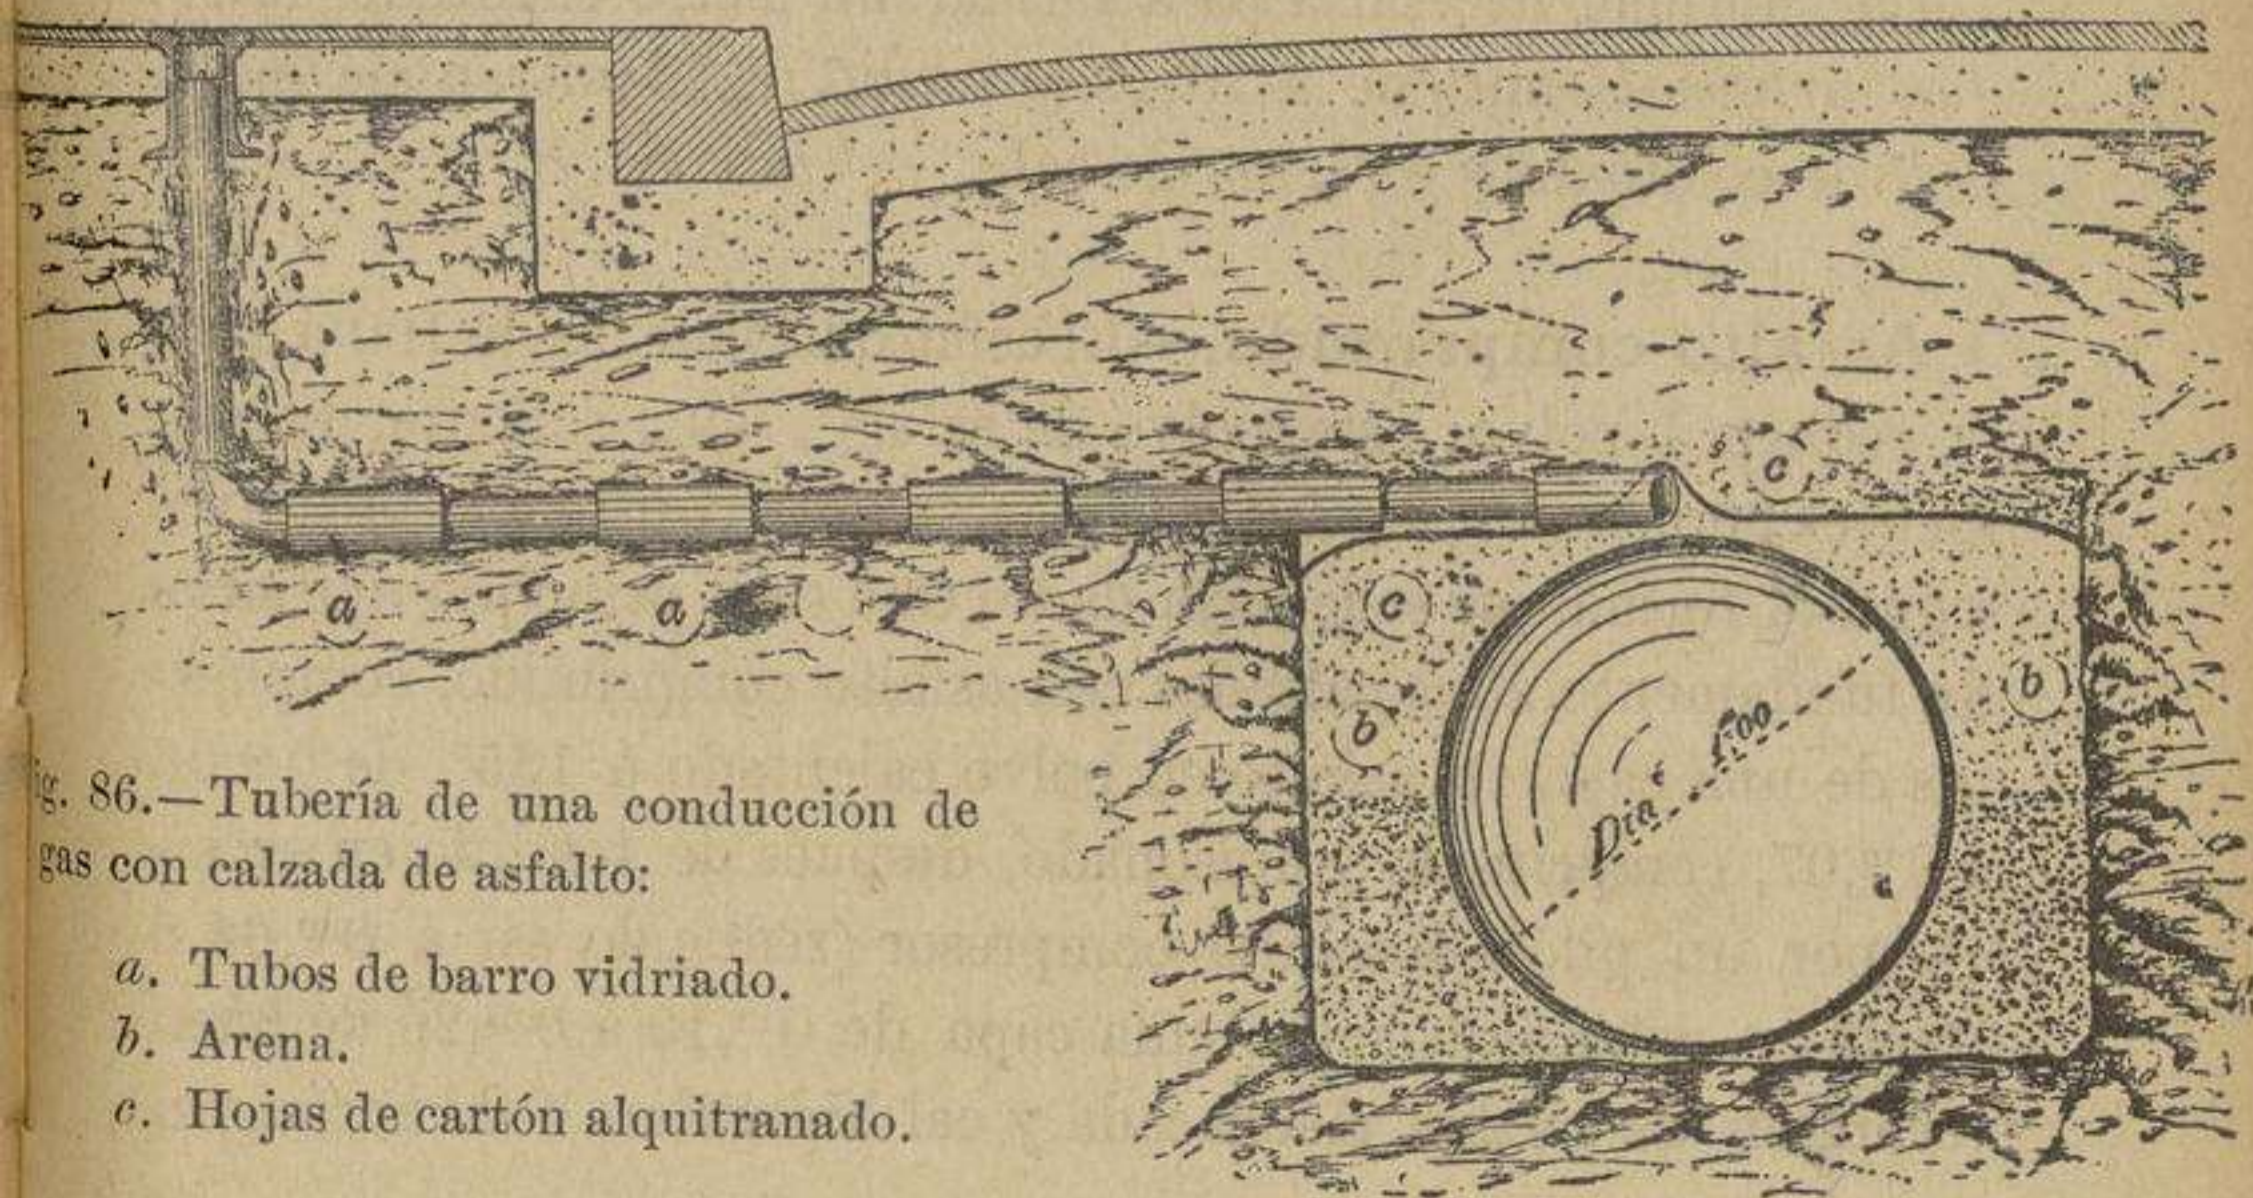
Tubería de una conducción de gas con calzada de asfalto:
